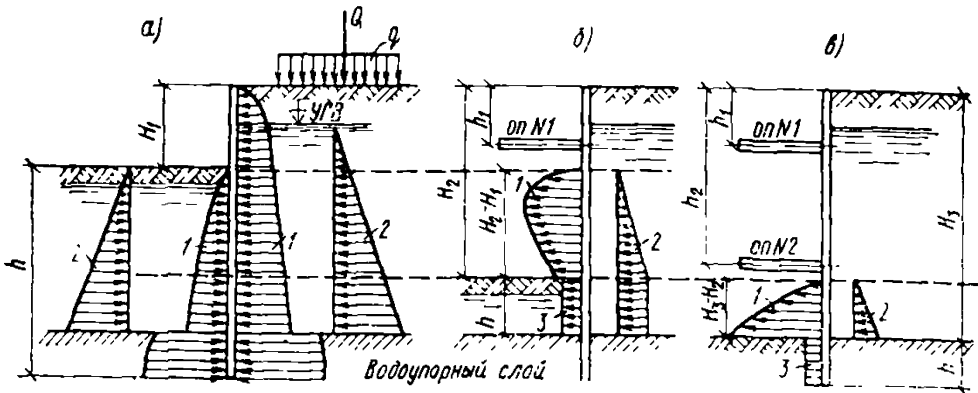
Расчетные схемы стенки с опорами в строительный период
